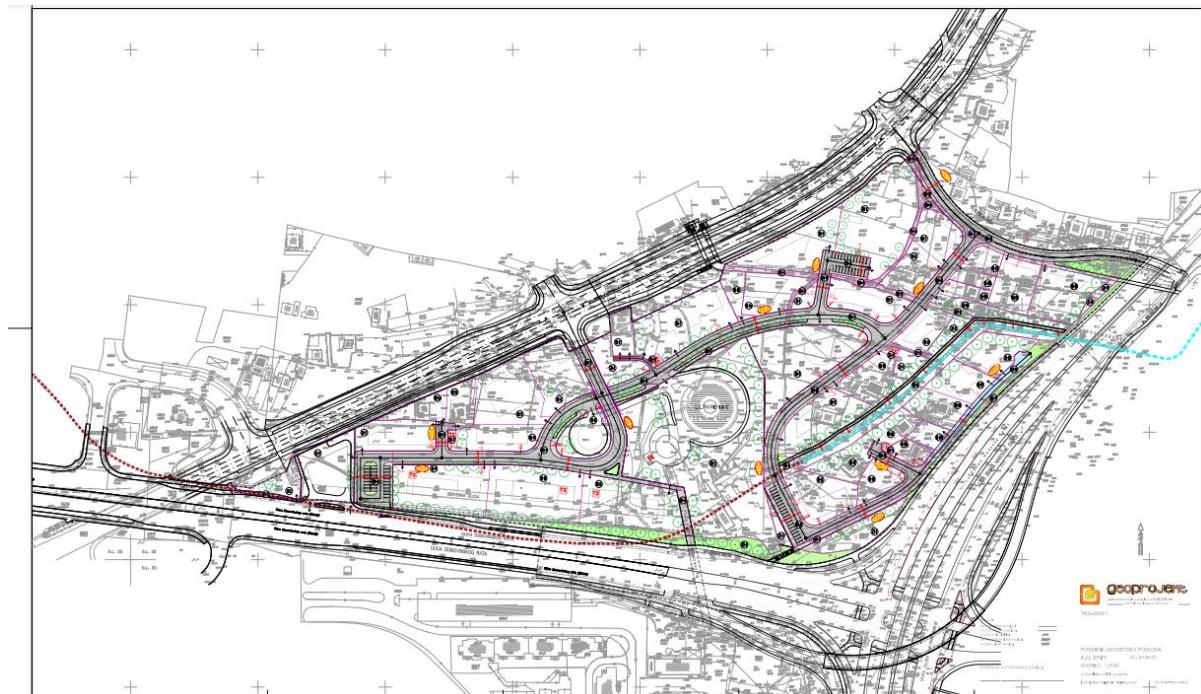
Detaljni plan uređenja istočnog dijela područja Duilova u Splitu-plan namjene površine [6]
